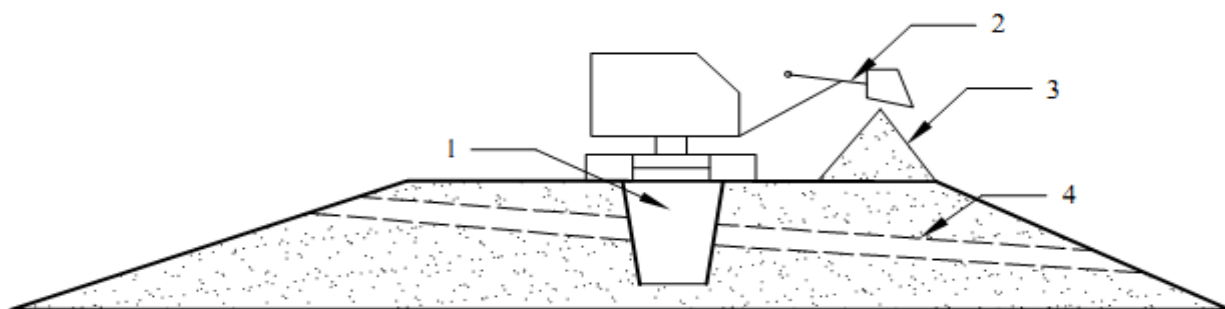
Схема перемишывания высевки с грунтом на откосе специальной фрезой
